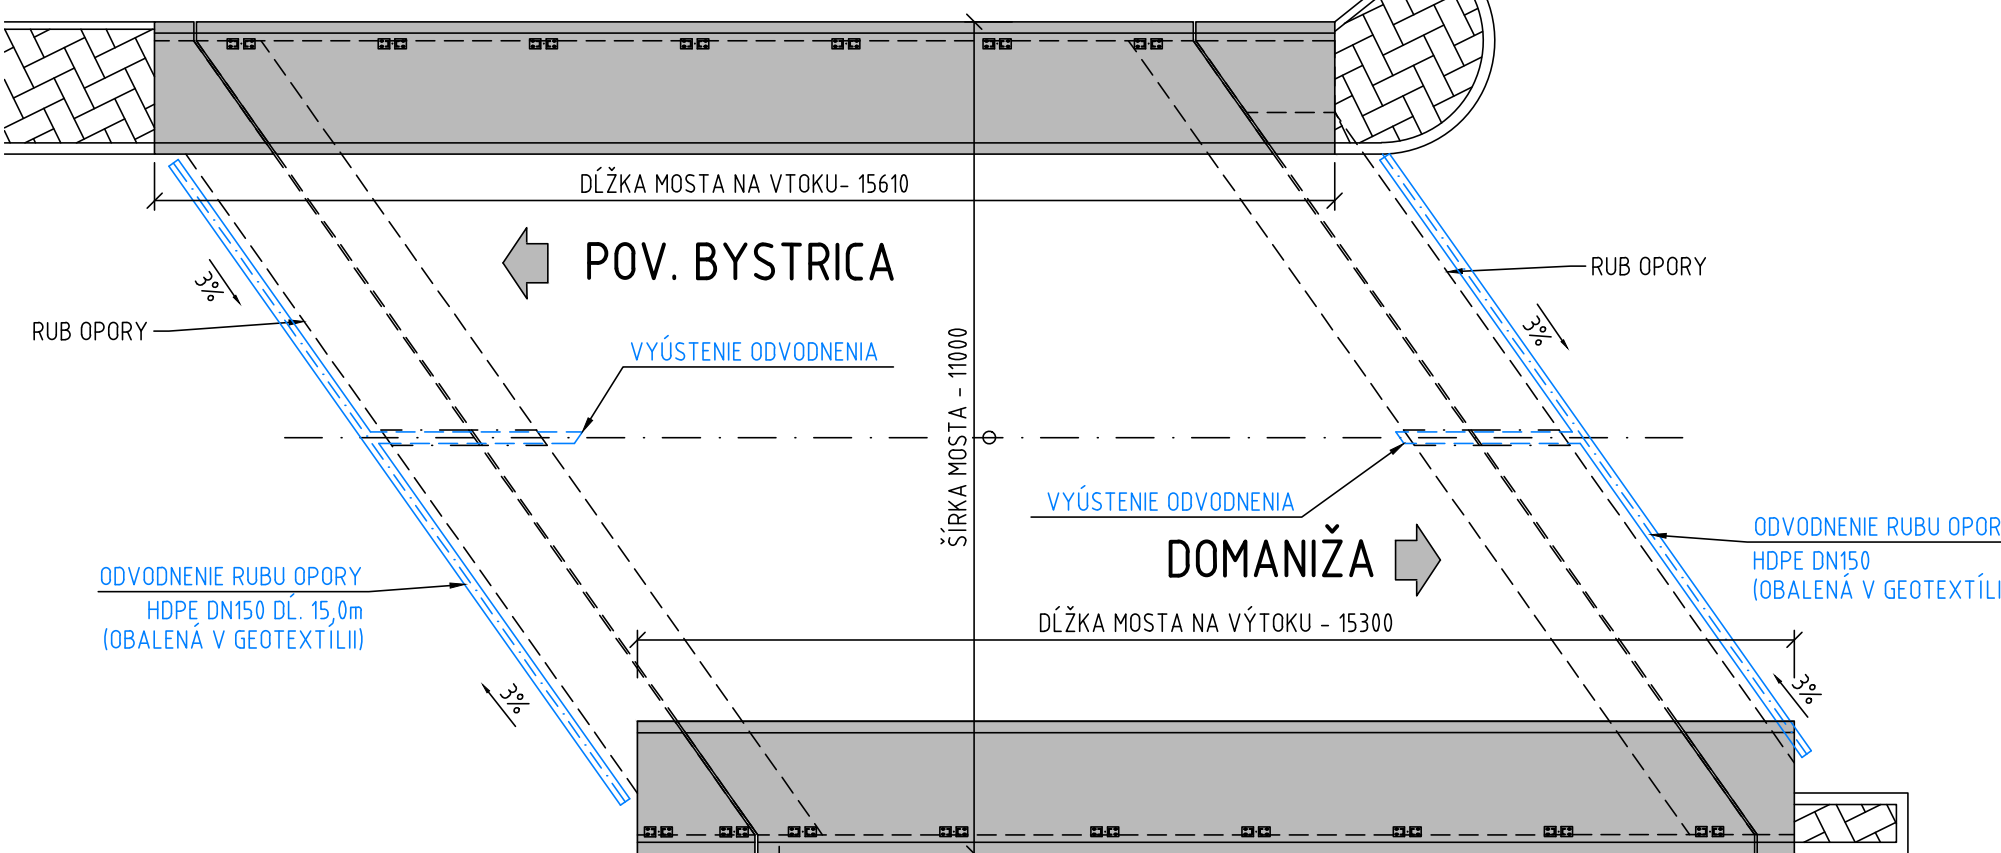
## DETAIL ODVODNENIE POVRCHU IZOLÁCIE M 1:20
